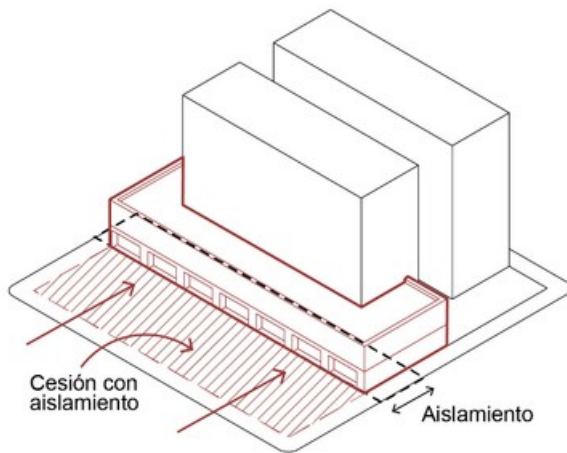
Los aislamientos contra cesiones públicas podrán ser ocupados para construir fachadas activas.
